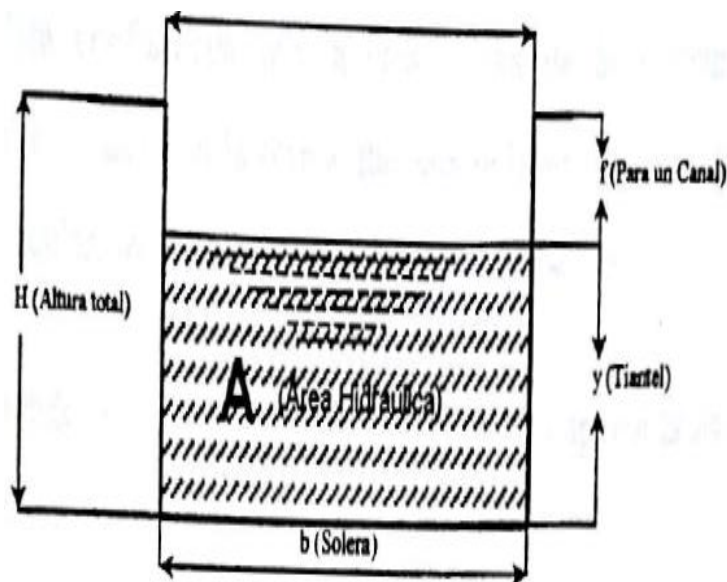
Sección rectangular de un canal (Fuente: Walter Morales Uchofen, "Infraestructura de Riego")
